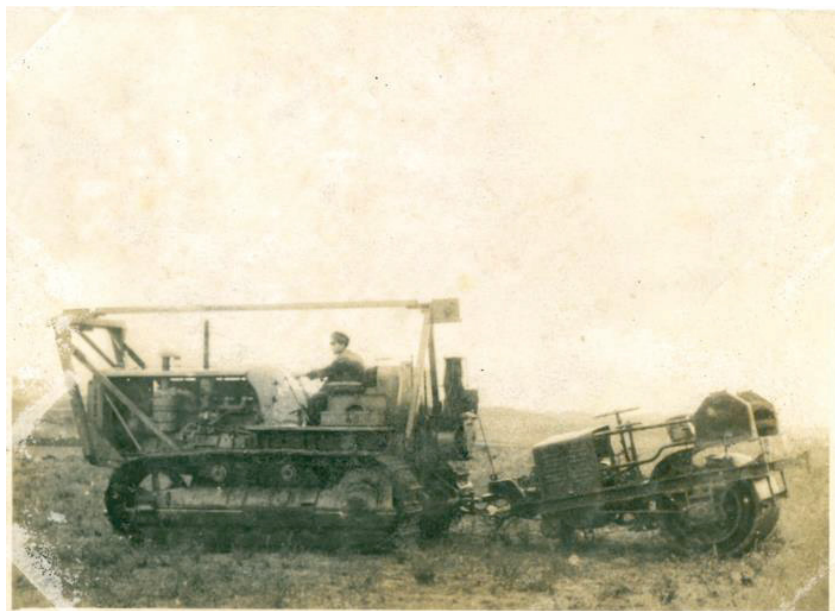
Cilindro utilizado nas obras de construção do Campo de Aviação, a ser rebocado por um “caterpillar”. Fonte: ADMMA, FIA 756
